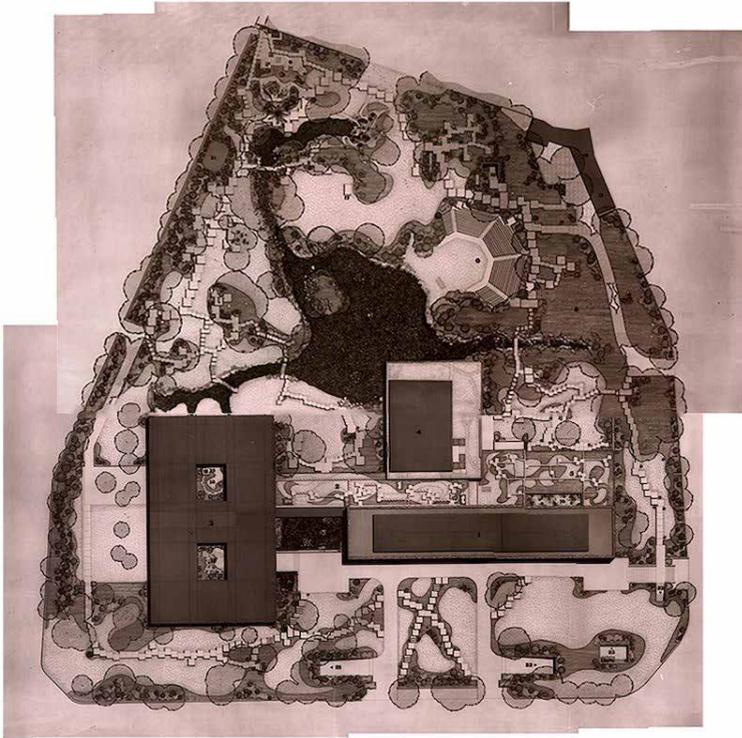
Planimetria generale ad avvenuto completamento della prima fase di intervento (1969) redatta da G. Ribeiro Telles. Archivio Fondazione Gulbenkian, Lisboa.
